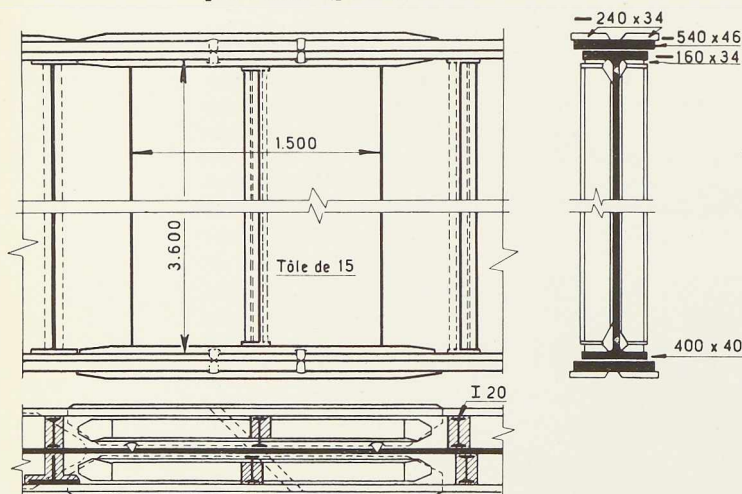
Joint bout à bout des poutres du pont-rails (partie Krupp).
